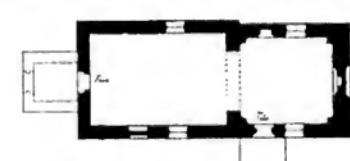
Grundriss der Kirche. Taf. 1.
